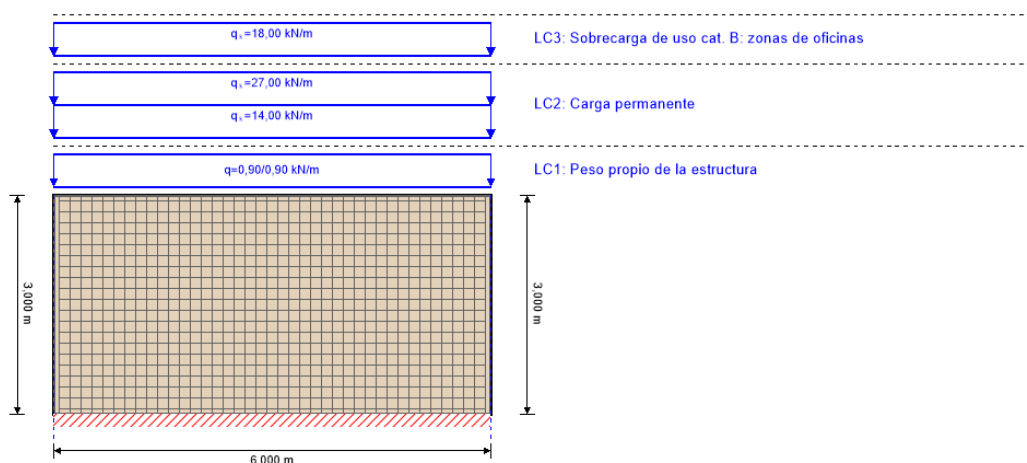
Esquema de cálculo con carga distribuida para los muros perimetrales.
